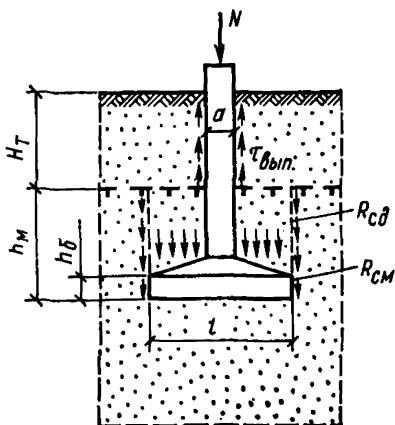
Схема взаимодействия грунта и фундамента при расчете на устойчивость при пучении
